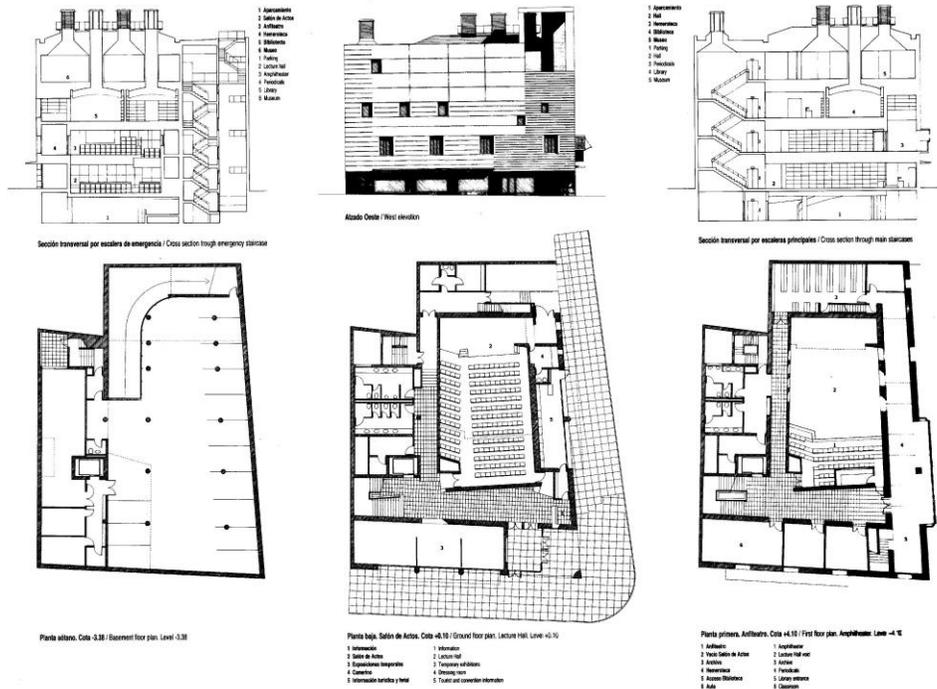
, plantas y secciones, Casa de la Cultura., fuente: Revista el Croquis edit. 98. 1999
